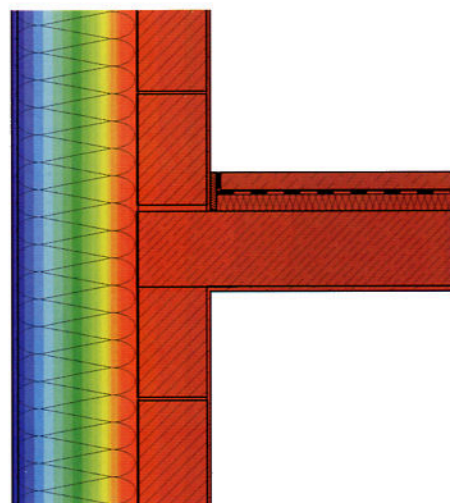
Flux thermiques du mur extérieur - dispositif d'appui en béton armé
